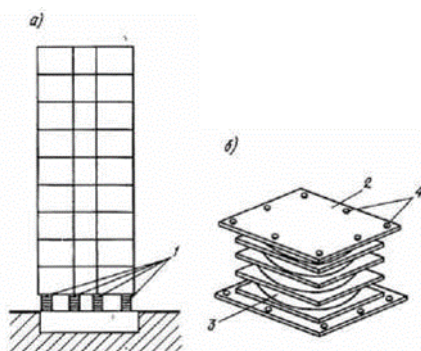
Сейсмоизоляция здания с помощью резинометаллических опор: *а* - схема установки опоры; *б* - схема конструкции опоры ОАРЕС; 1 - опора; 2 - стальная плита; 3 - слой неопрена; 4 - отверстия для анкерных болтов
